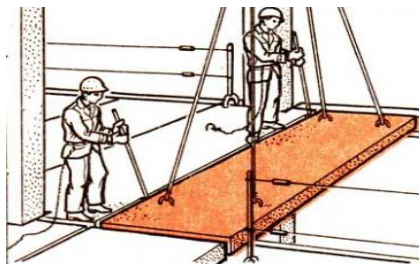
Наведение, ориентирование и установка плит перекрытия
